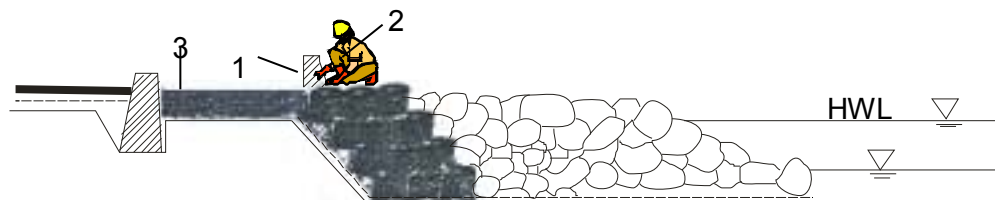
Penyusunan buis beton dan pengisian beton cyclop
